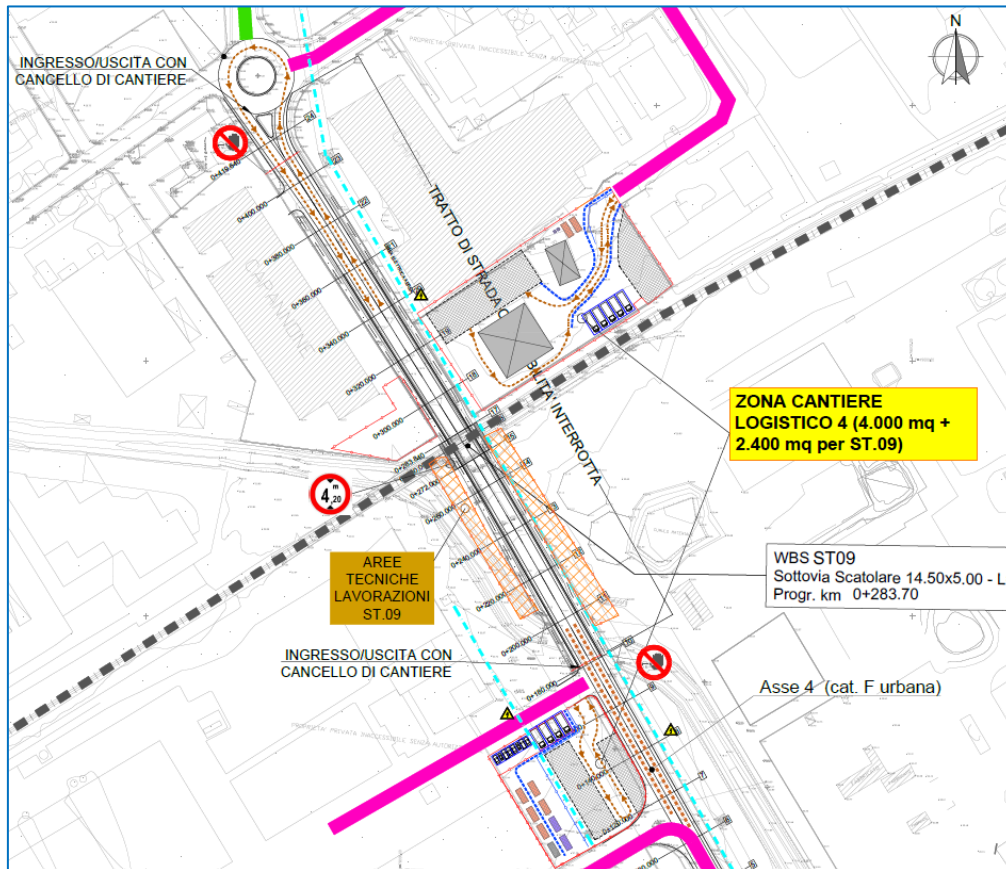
viabilità per accesso all'area tecnica di lavoro ST.09
